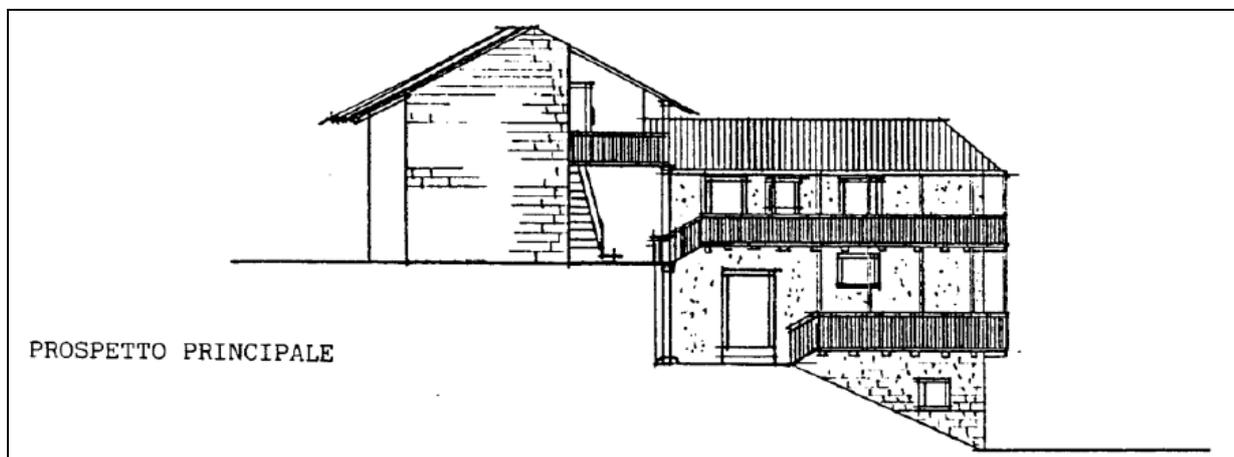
Prospetto principale di abitazione tipica rurale con ballatoio (Fonte: NTA del PRGC).
